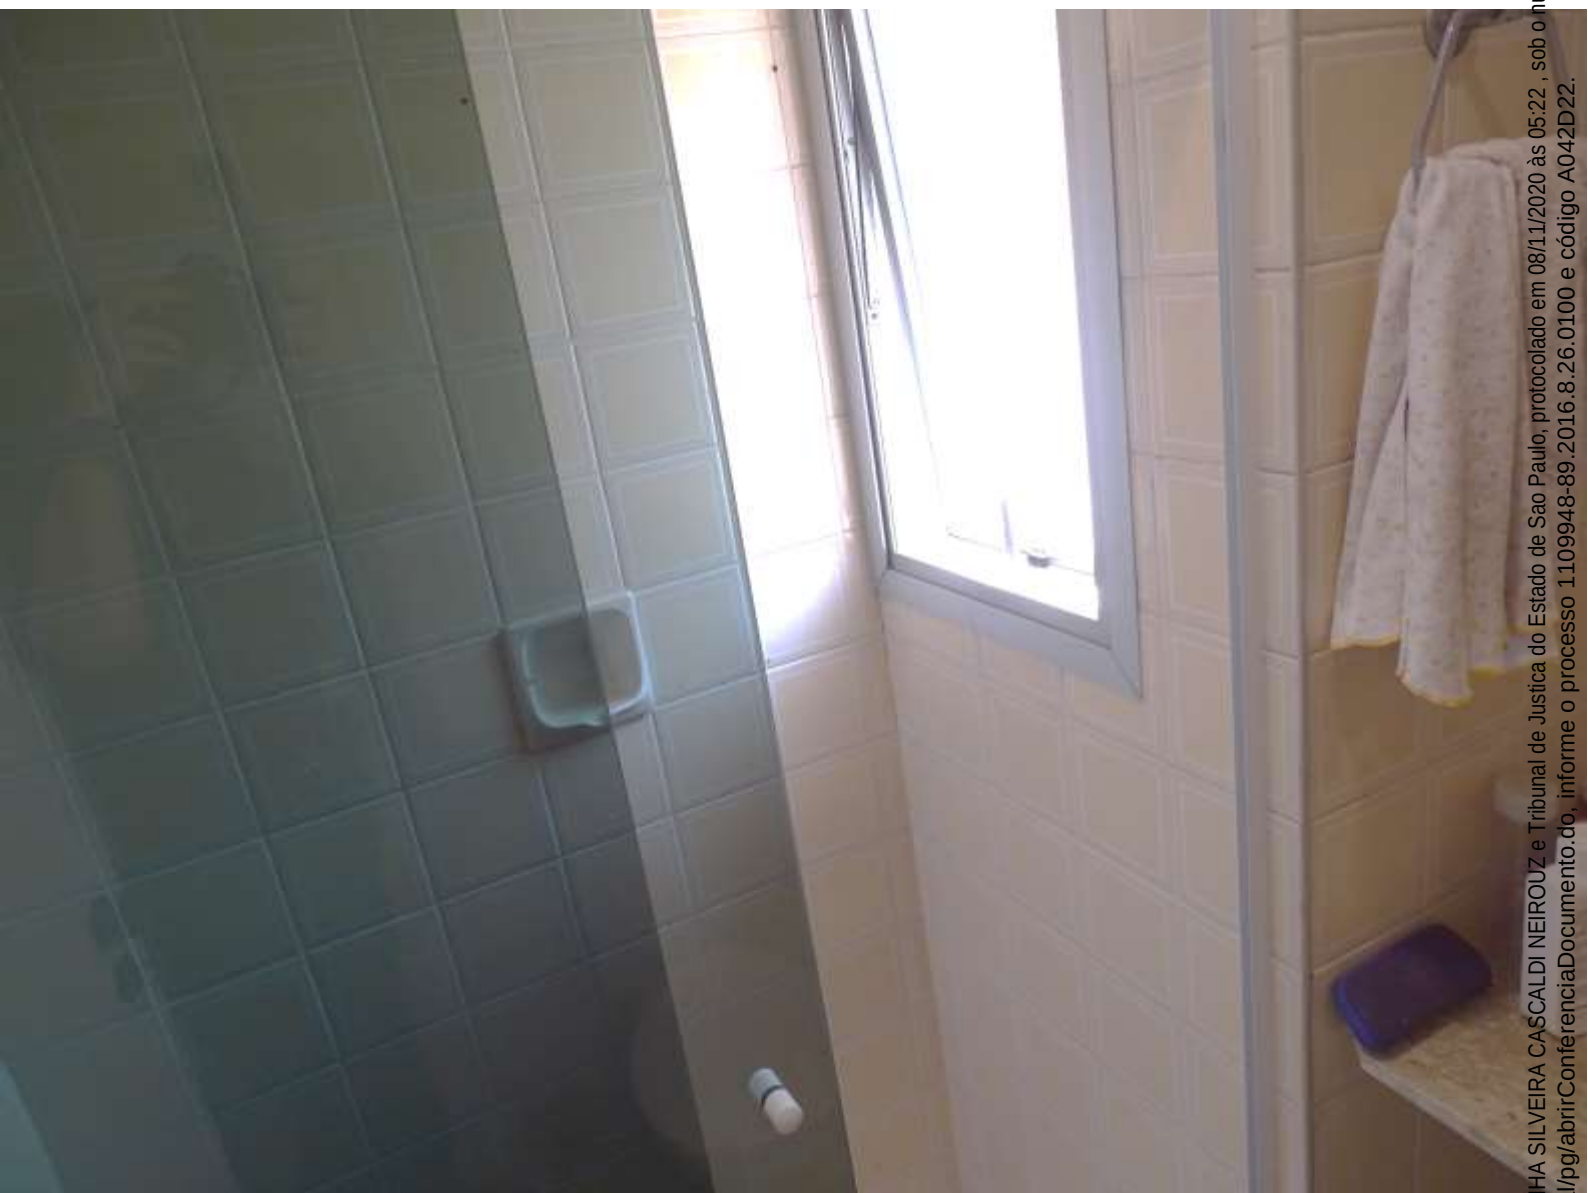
BANHEIRO / SUÍTE –VISTA-2
